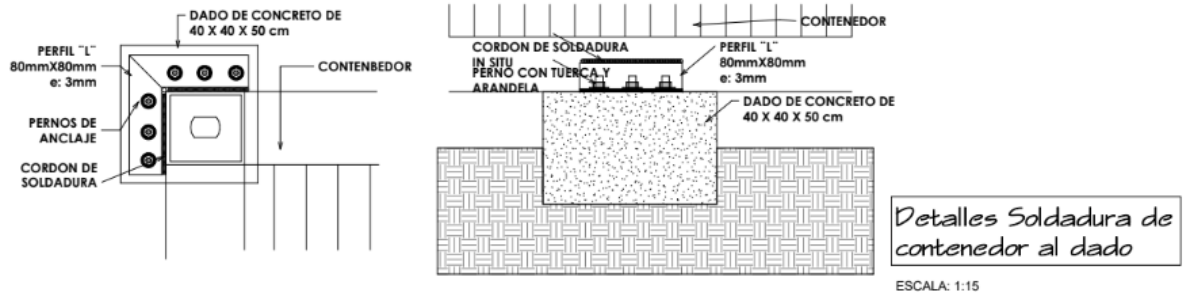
Detalle soldadura de contenedor al dado
